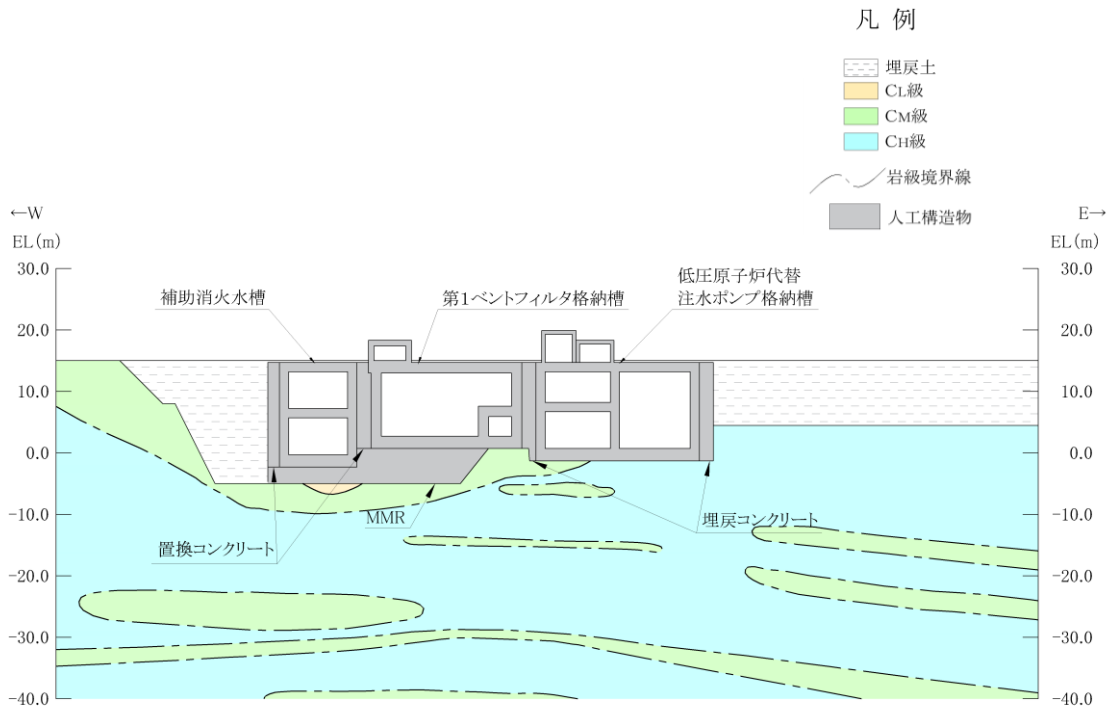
(3) 低圧原子炉代替注水ポンプ格納槽 地質断面図 (C-C断面)
